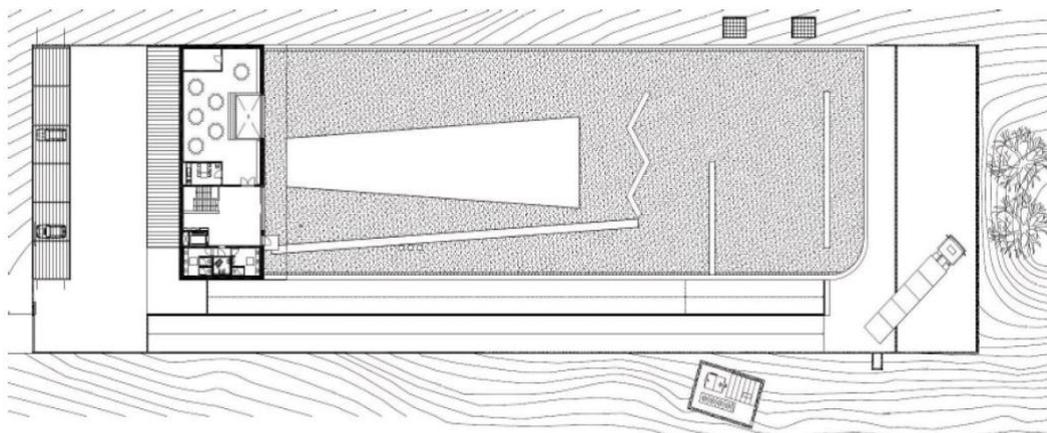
Adega Mayor – Planta do Piso 2²⁸
